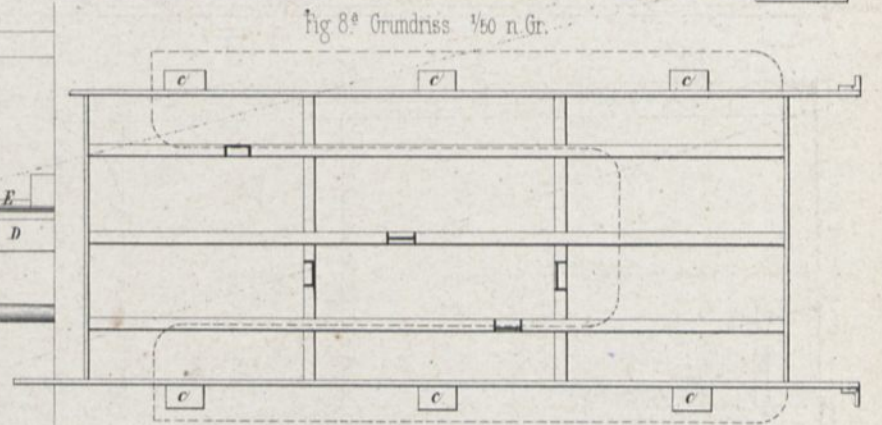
^a Grundriss 1/50 n.Gr.
